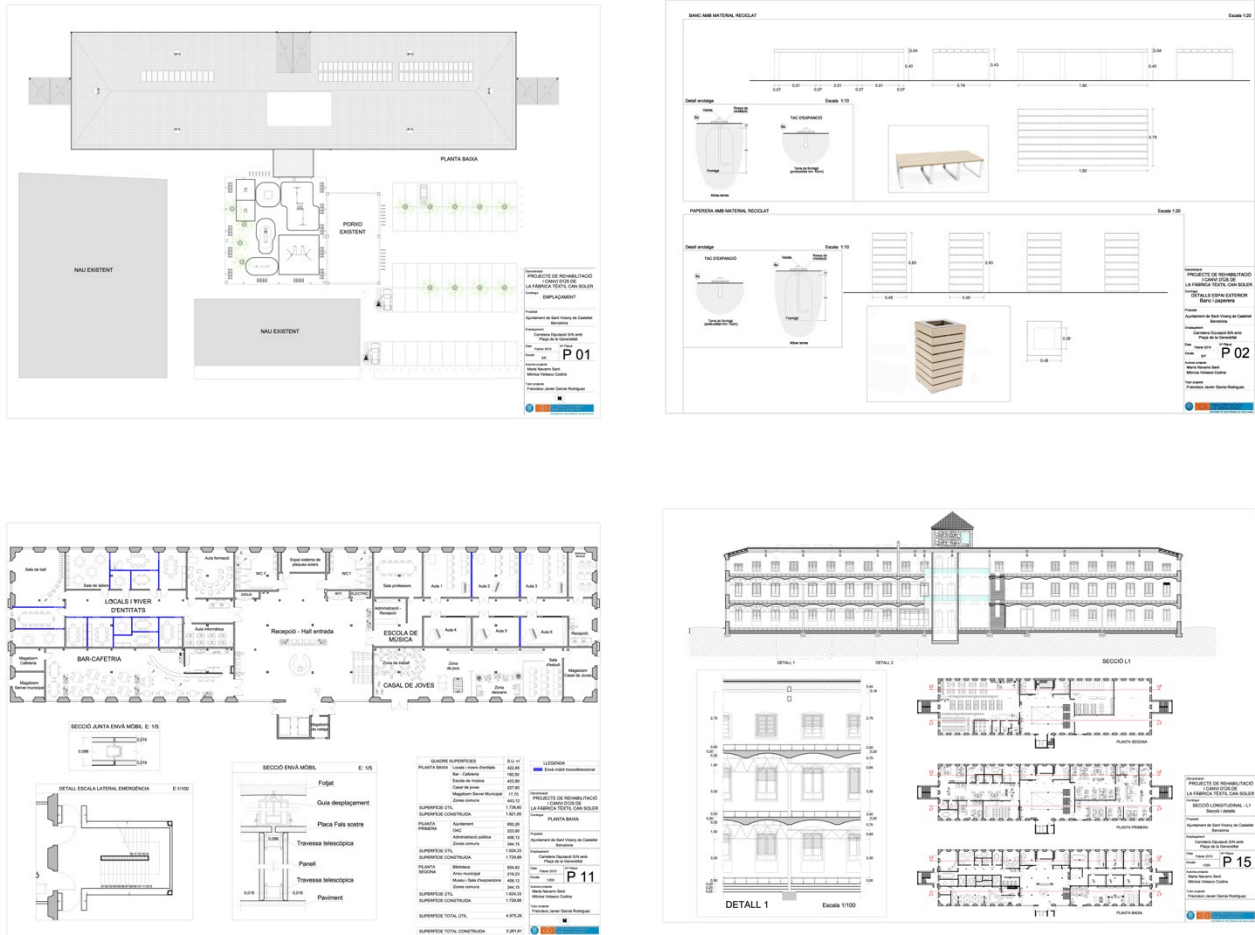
Reproducción de planos de planeamiento exterior, planta reformada y secciones
